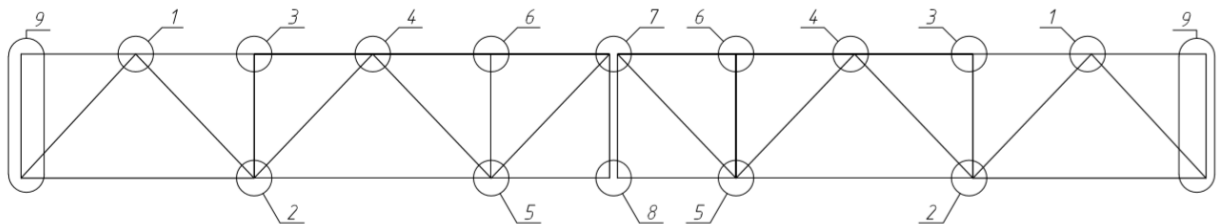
Схема расположения узлов к расчету и конструированию узлов фермы
